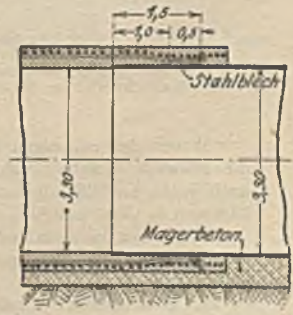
Anschluß des Eisenbetondruckrohres des Wasserkraftwerkes Champ an das Druckrohr aus Stahl
